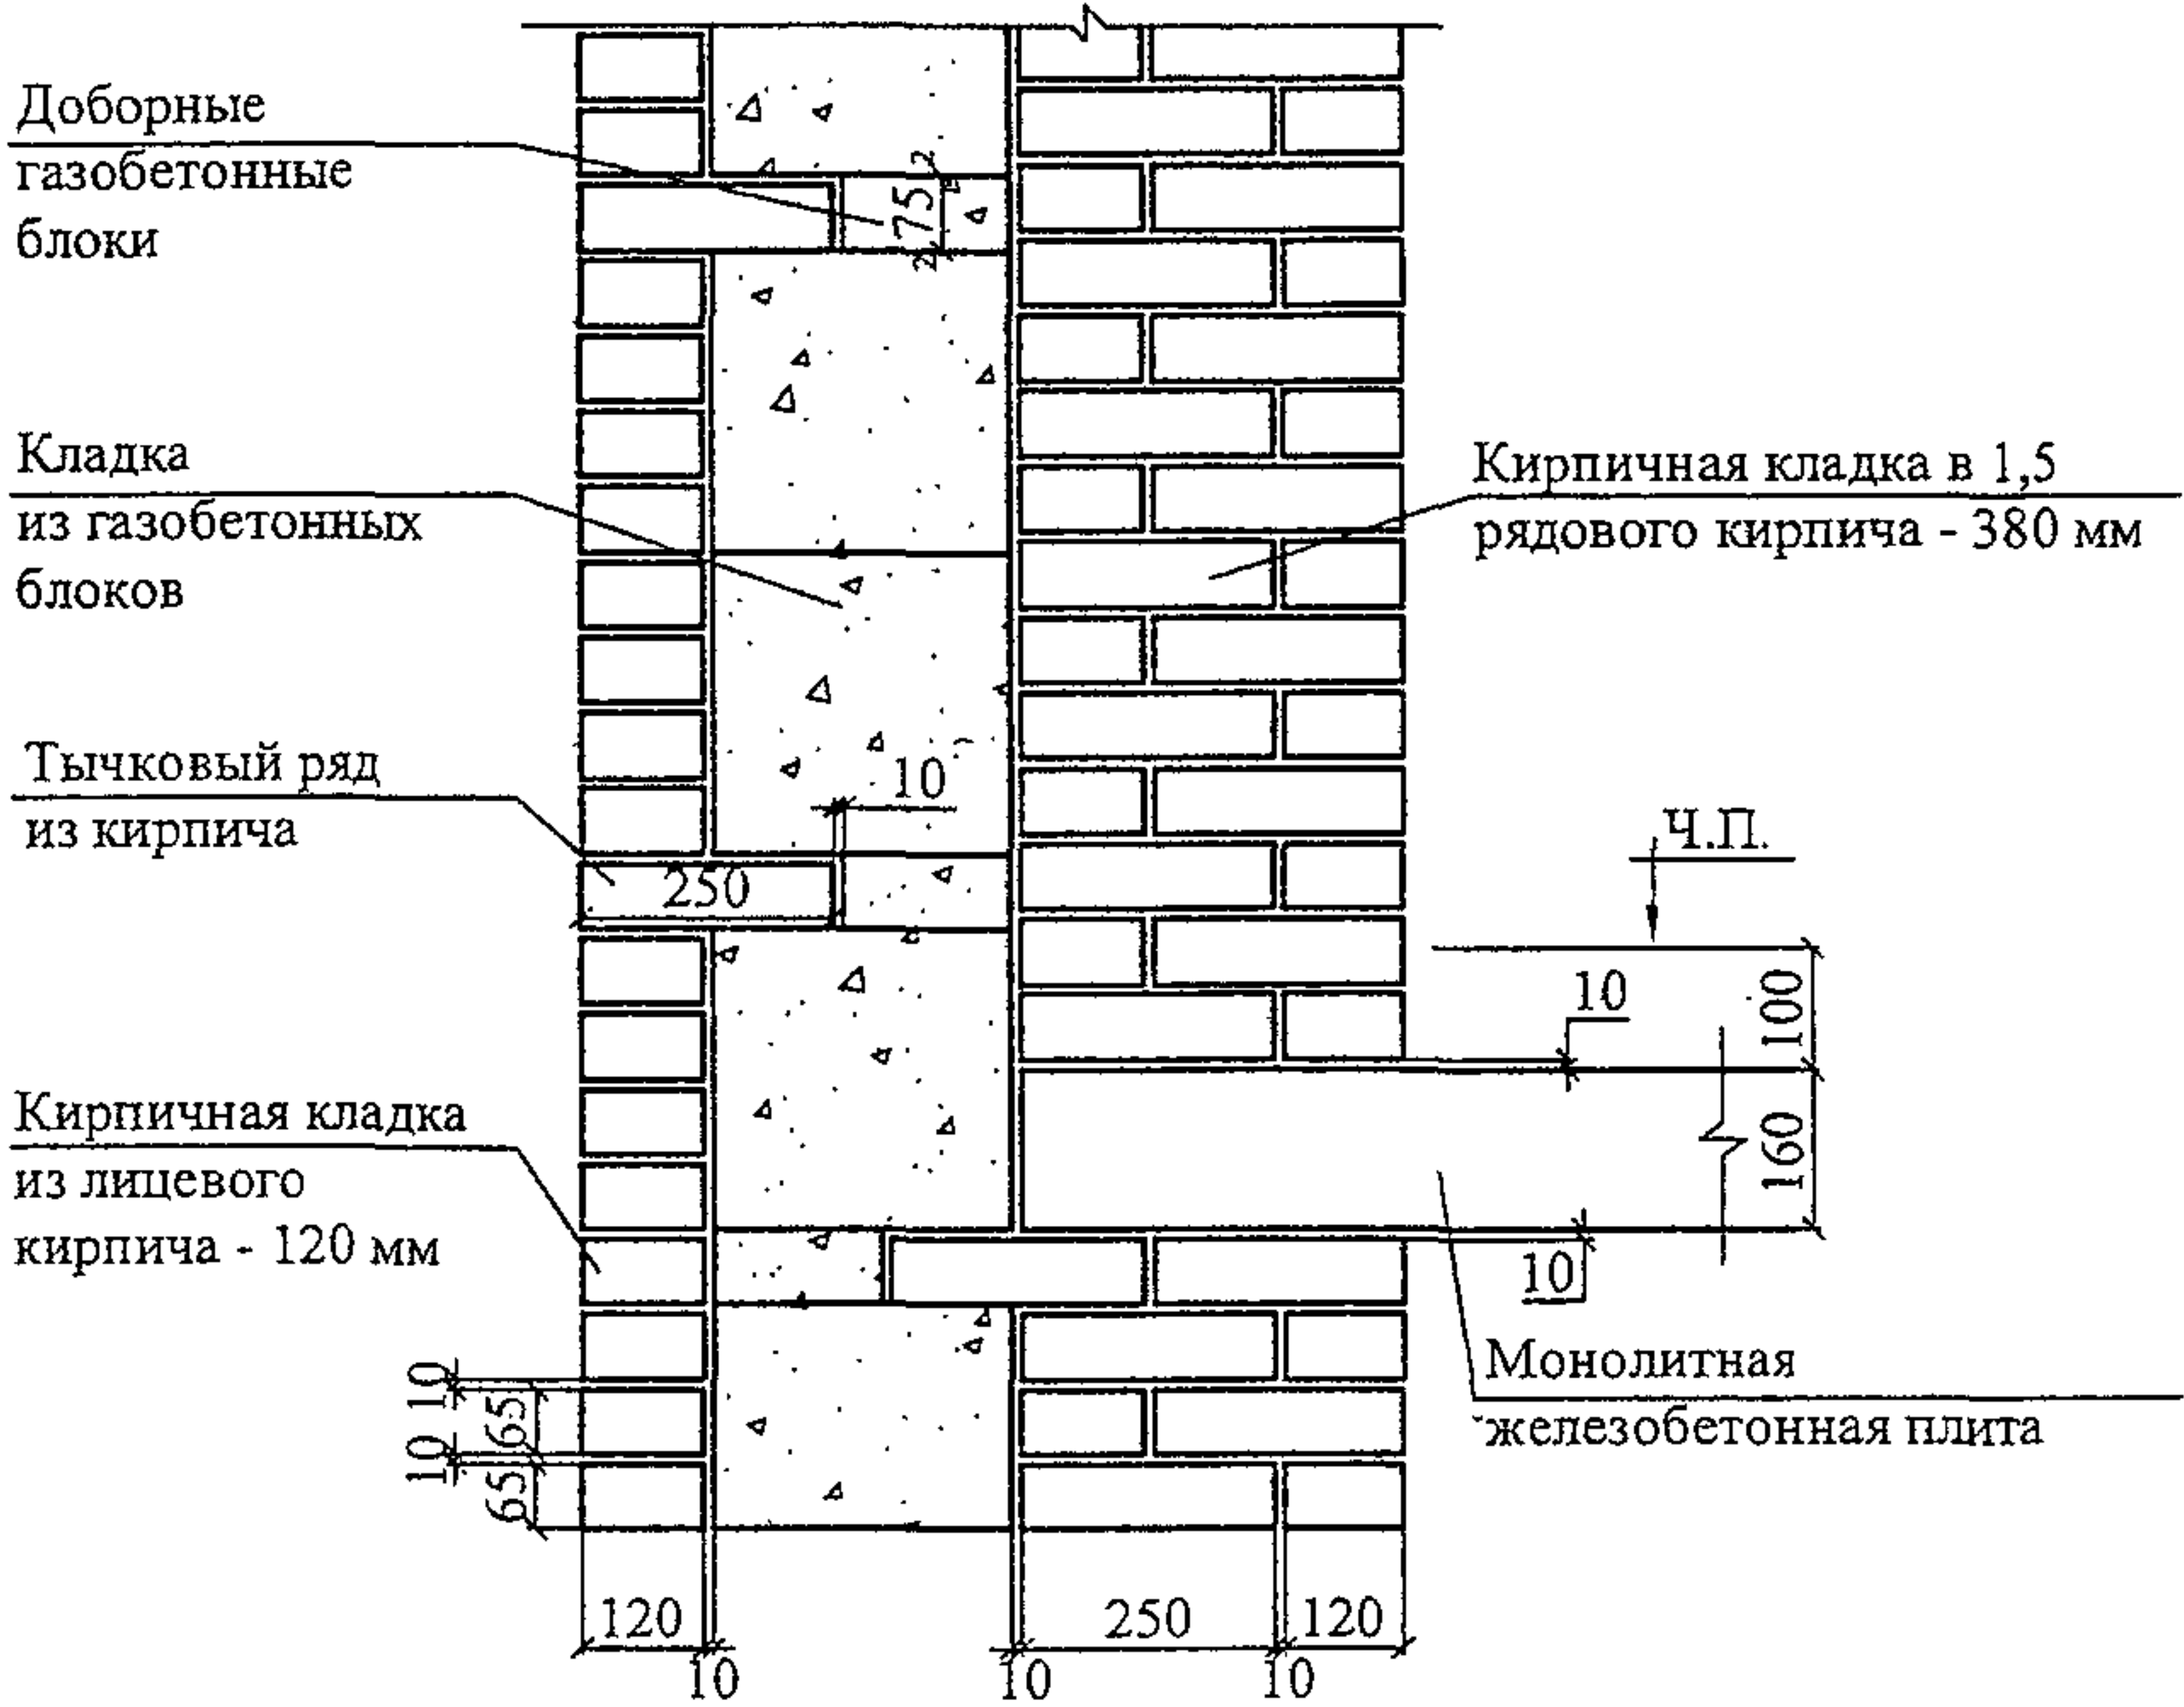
Несущая кирпичная стена малоэтажных домов с наружными газобетонными самонесущими блоками на клею и кирпичной облицовкой с анкерровкой тычковыми рядами
